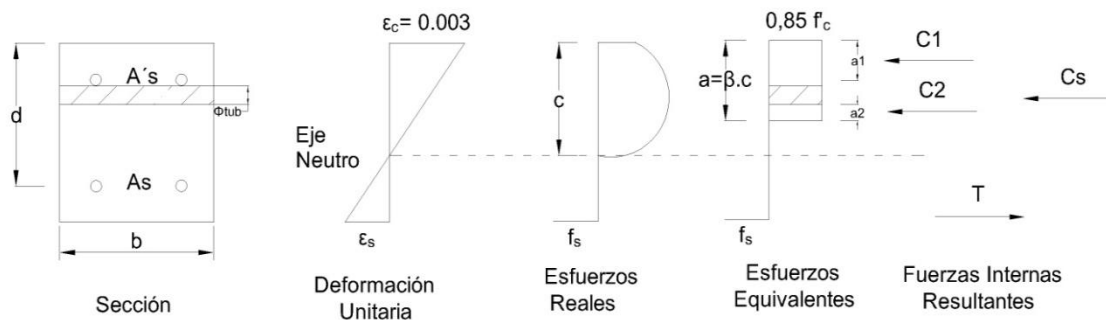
Sección de concreto doblemente Reforzada afectada por tubería en caso 1.
